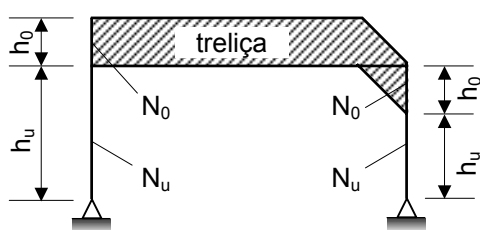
Pórtico bi-rotulado com treliça horizontal. Fonte: DIN 1052/88
